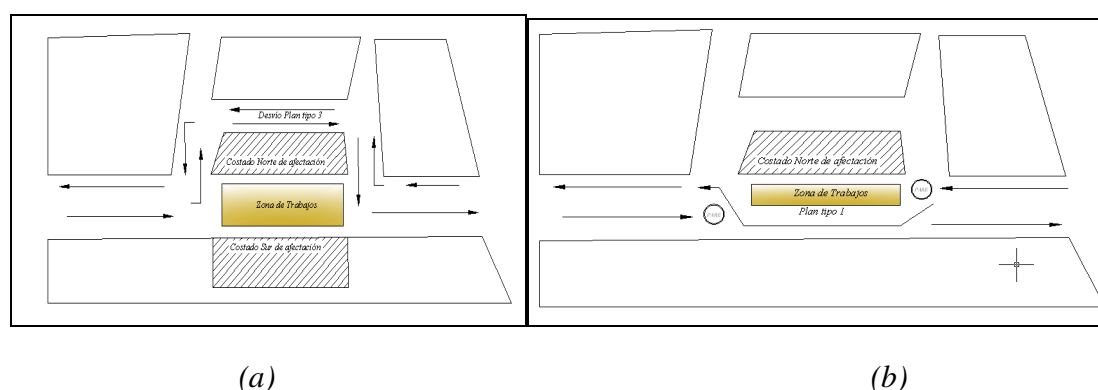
Esquema de las zonas de afectación (a) Alternativa de reemplazo con apertura de zanja abierta con concreto (b) Alternativa de reemplazo por rotura de tubería utilizando tubería de polietileno
